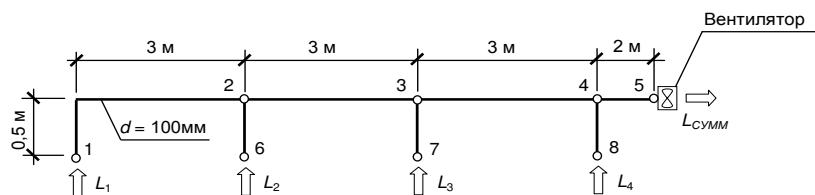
Расчетная схема системы вентиляции четырех помещений
